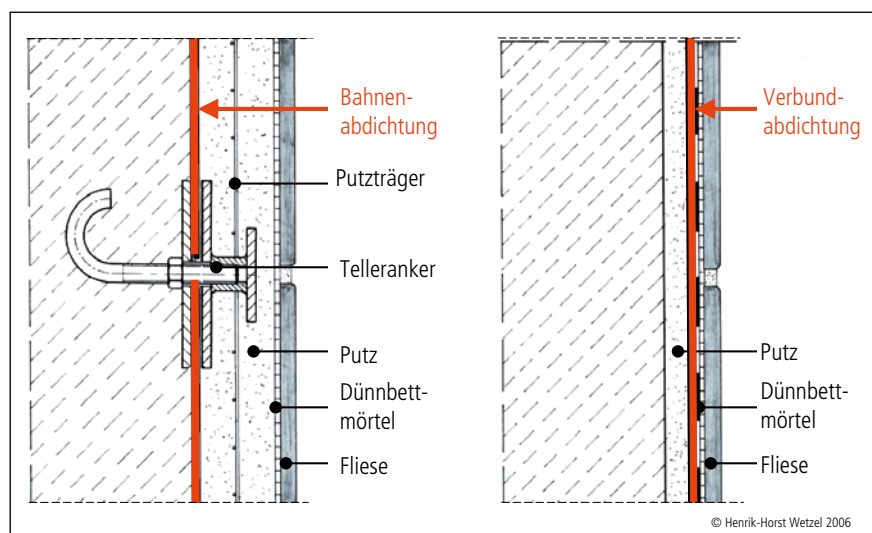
■ Wandaufbauten mit bahnenförmiger Abdichtung und Verbundabdichtung [40]
